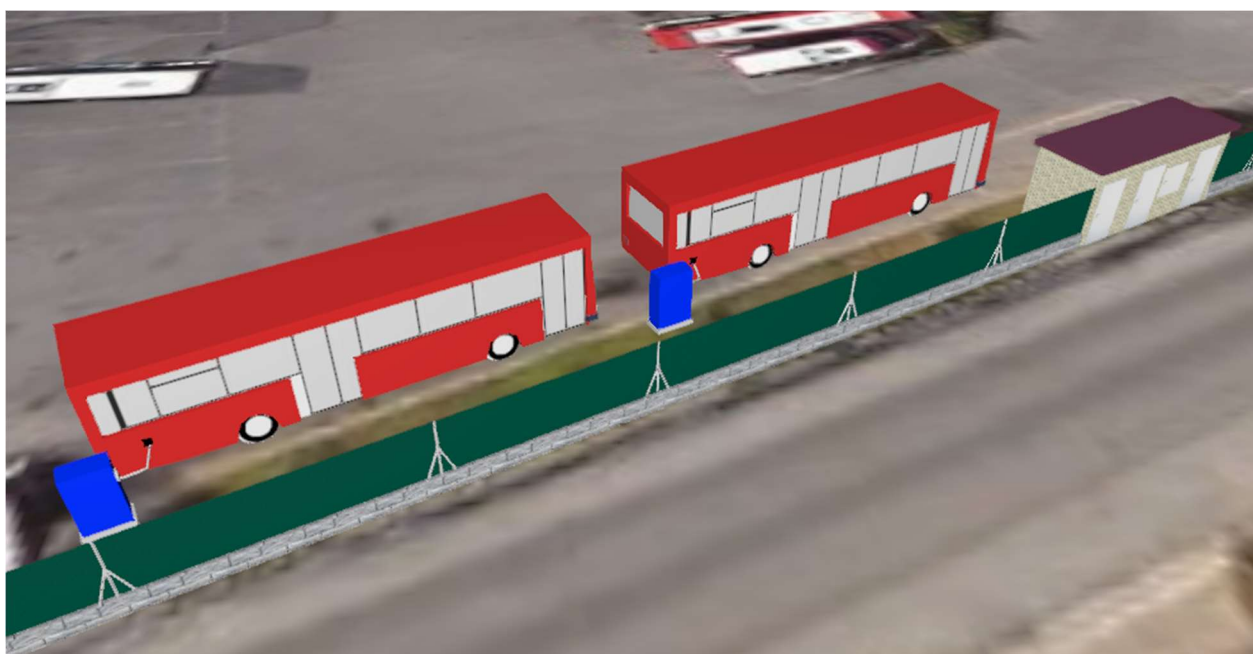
Ubicación propuesta para el nuevo centro de transformación y seccionamiento (vista 3D).
